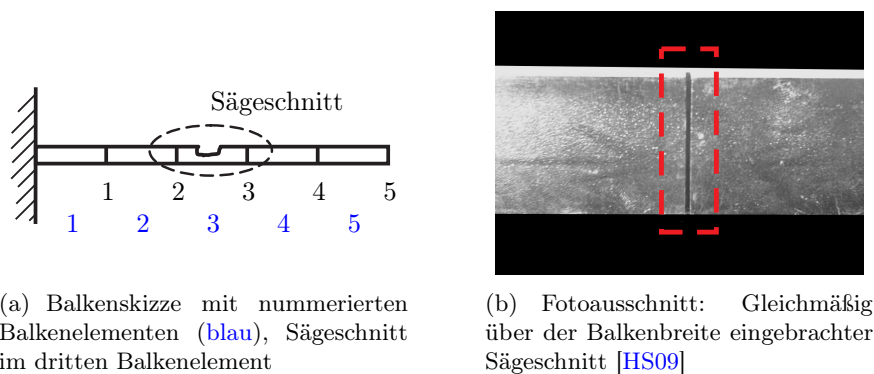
Sägeschnitt als (künstlichem) Strukturfehler des Biegebalkens
